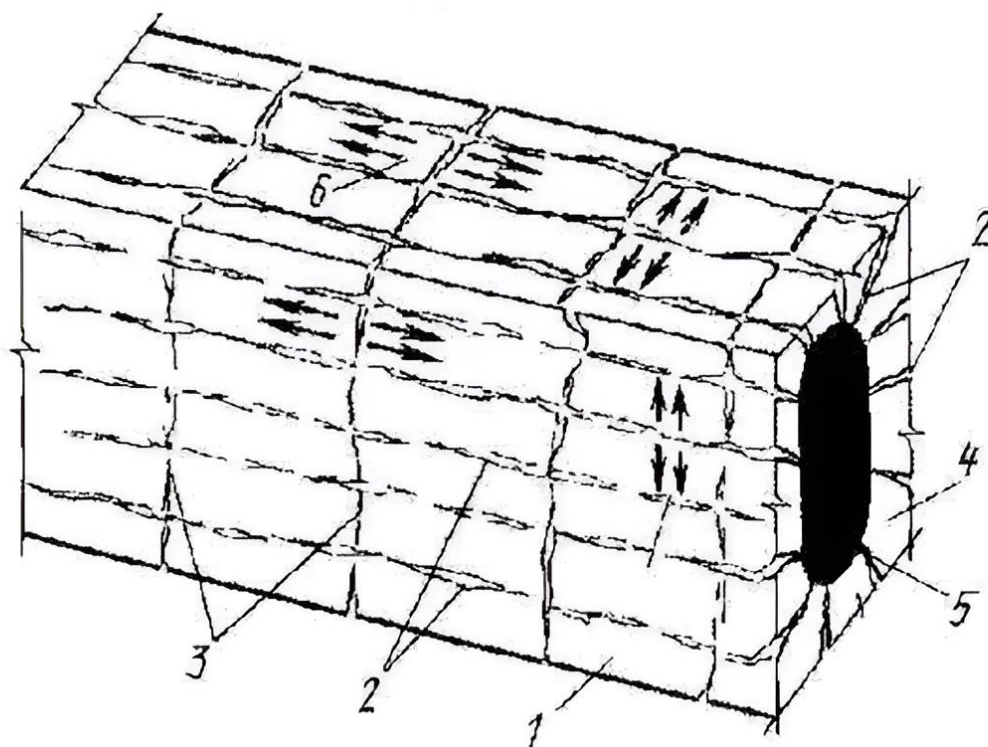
Схема образования трещин на поверхности образца от усадки бетона: 1 – фрагмент бетонной балки; 2, 3 – продольные и поперечные усадочные трещины; 4 – наружный (высохший) слой; 5 – внутренний слой; 6 – растягивающие напряжения
